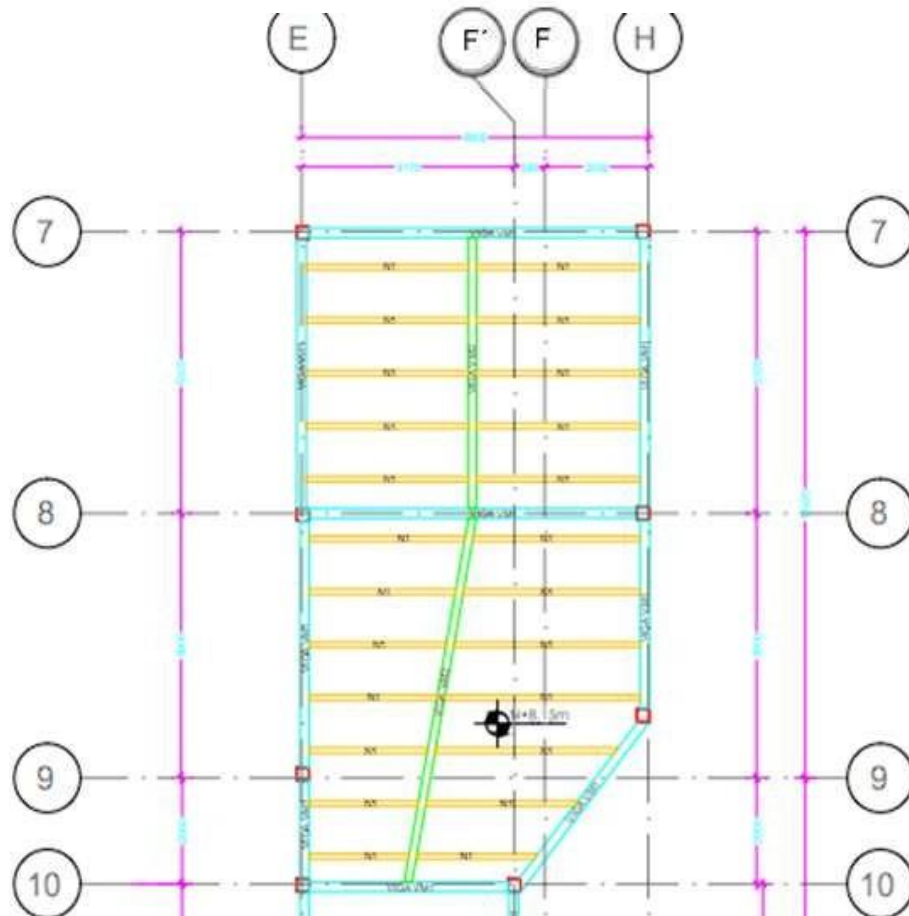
Losa de Cubierta (Redwood & Paredes, 2023)
